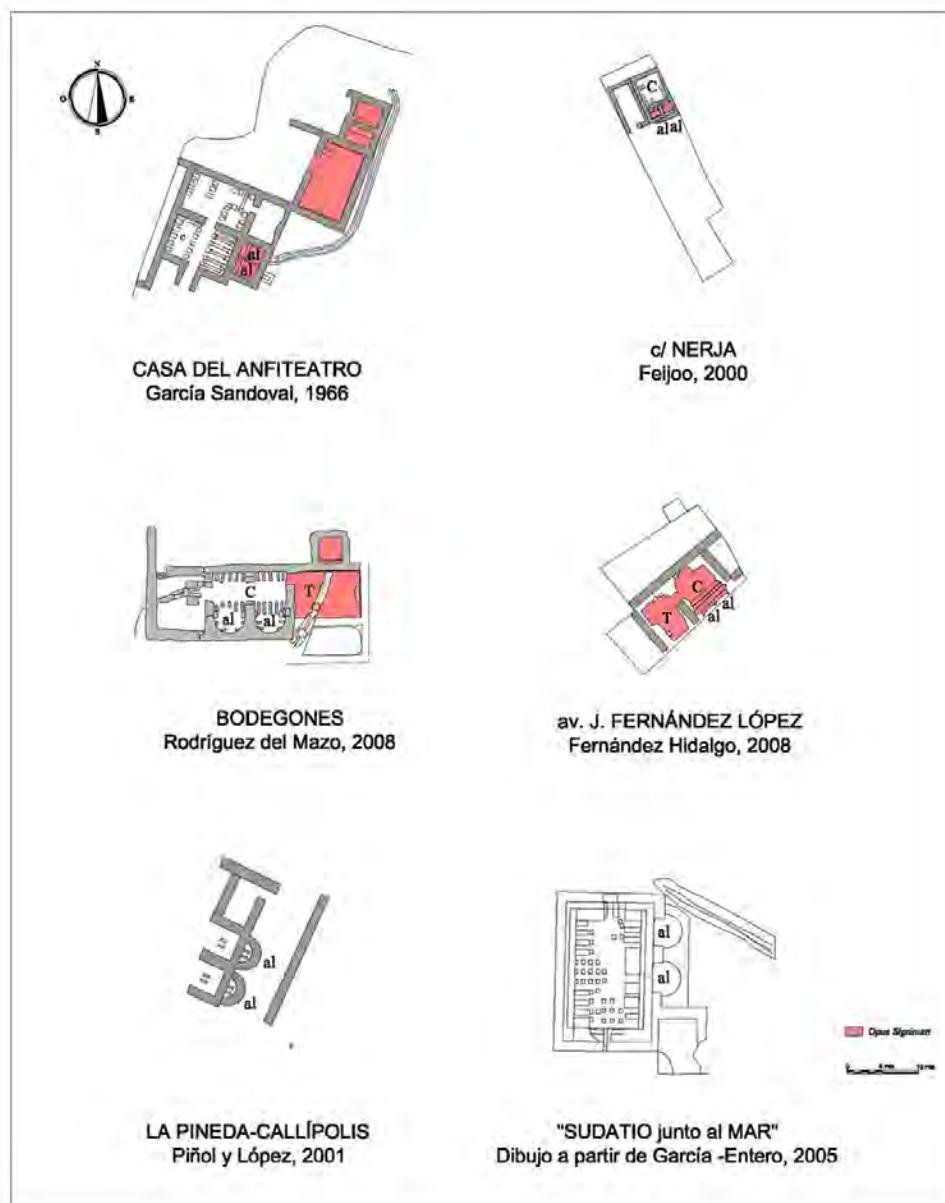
PLANTAS DE BAÑOS DOMÉSTICOS CON CALDARIA DE CABECERAS DOBLES. (Planimetría de autor).
